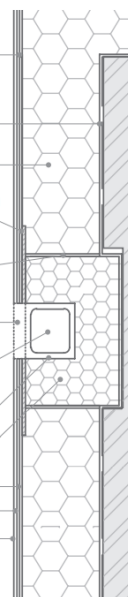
Узел крепления восточной системы к фасаду из облицовочных панелей
